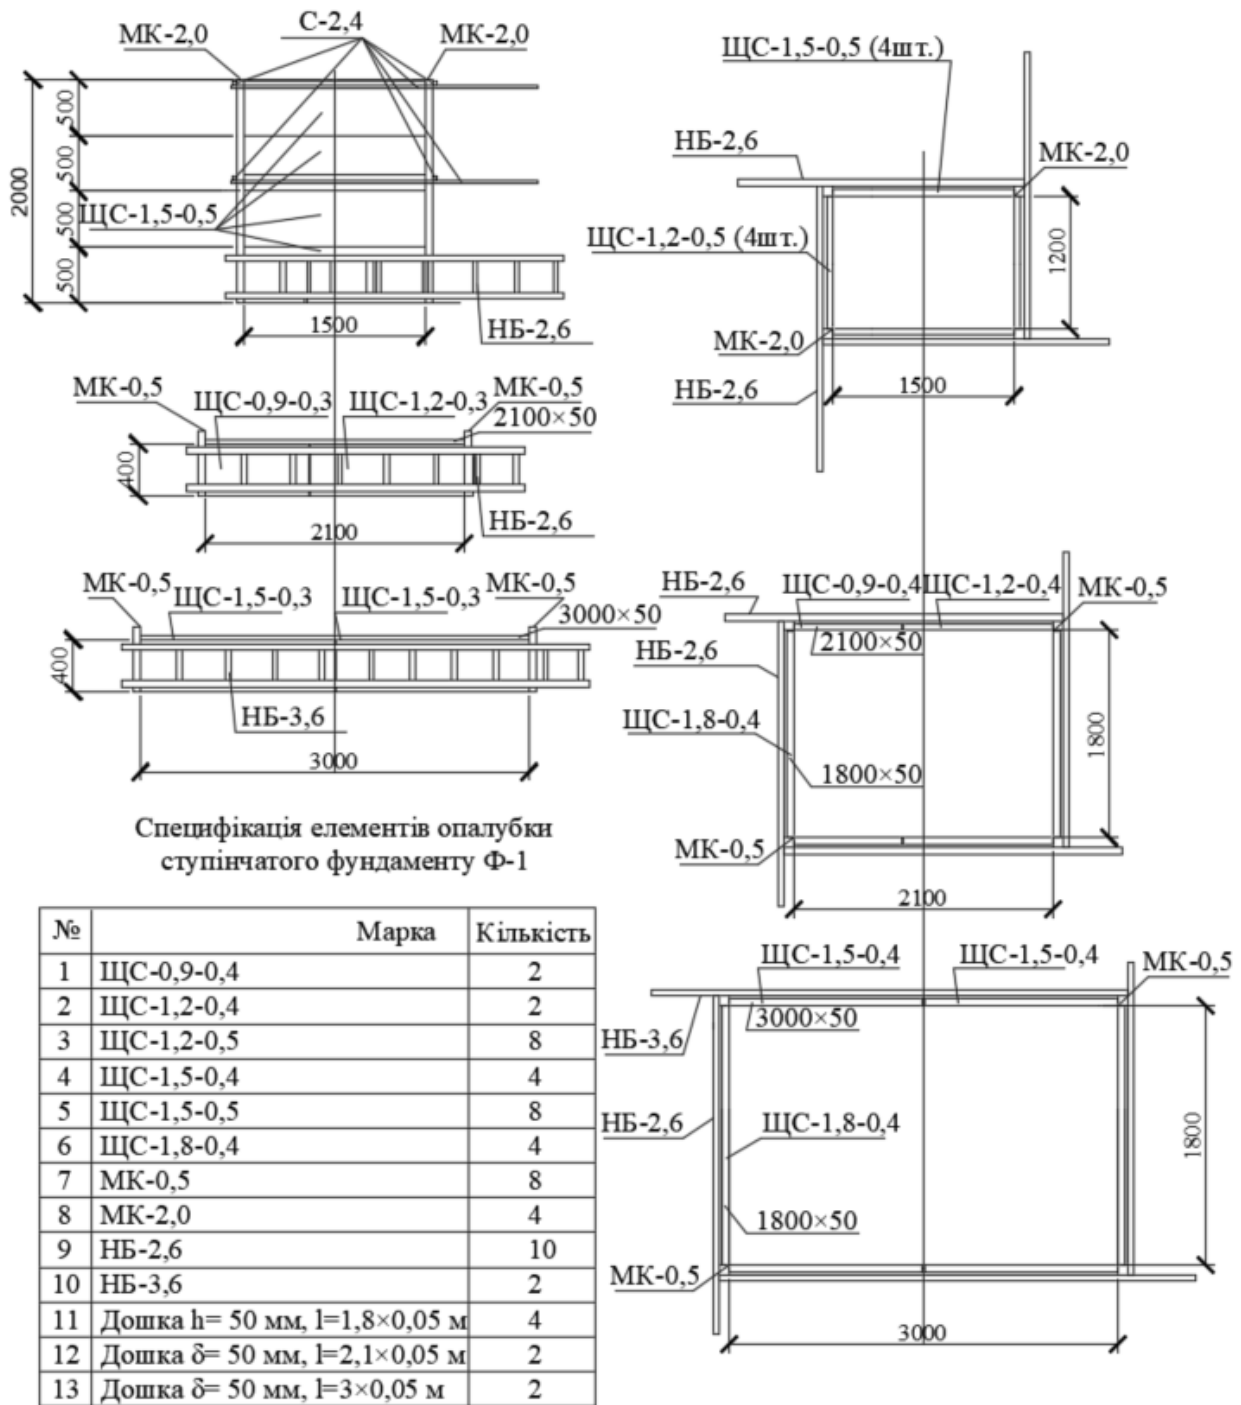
Маркувальна схема ступінчастого фундаменту зі специфікацією елементів опалубки
